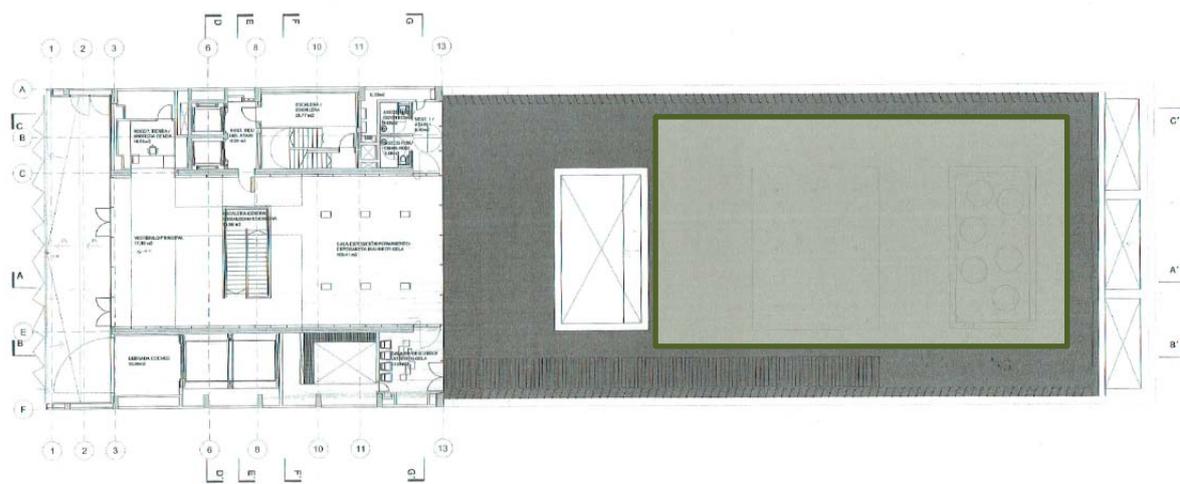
Planta baja del edificio, indicando ubicación prevista para el pabellón en el patio de manzana.
